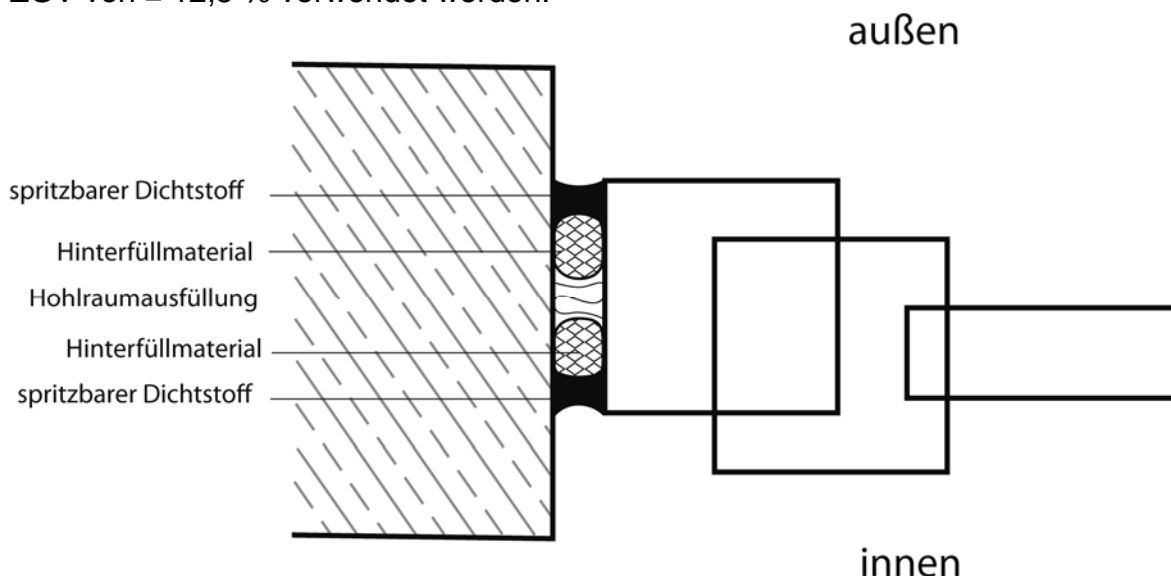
Fachgerechte Fugenausbildung bei stumpfem Anschlag
